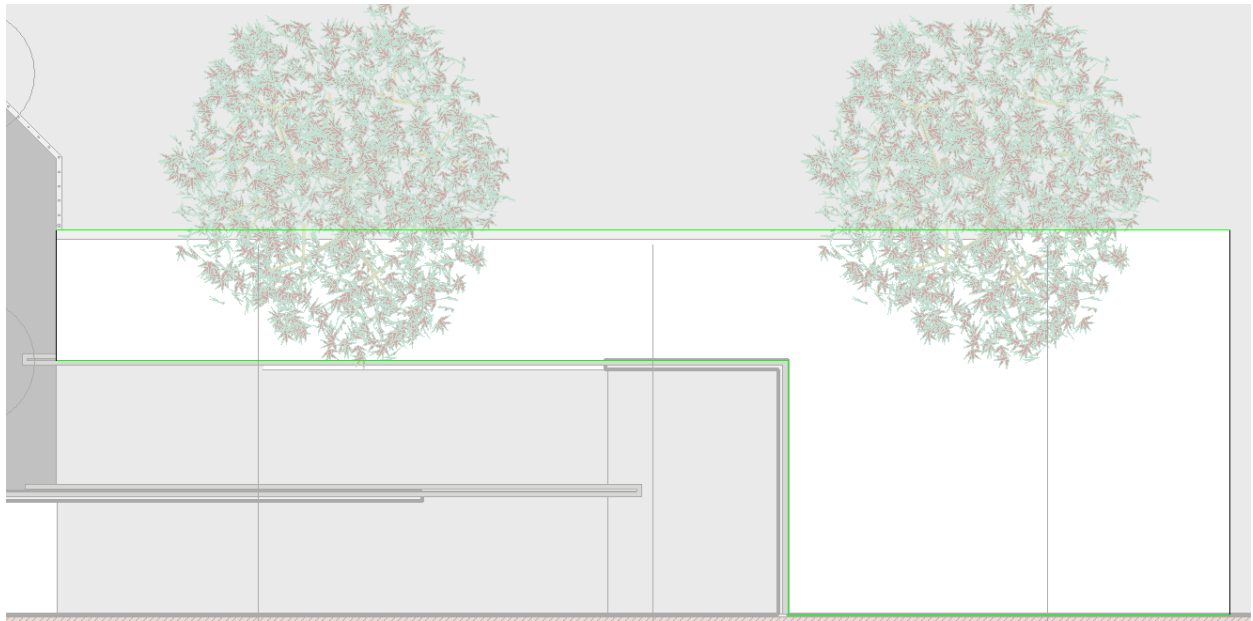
Vista en planta de la creación de rampas exteriores en el proyeco de Revit
